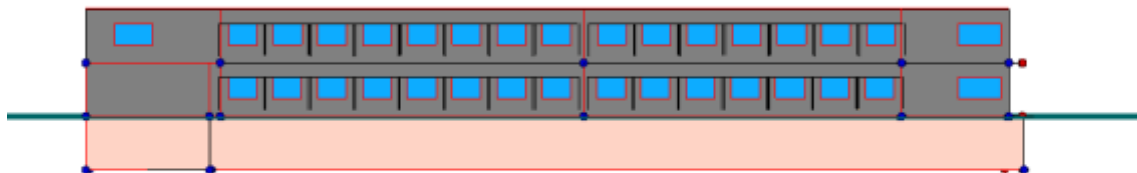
Alzado Y edificio 05. Fuente: Elaboración propia
